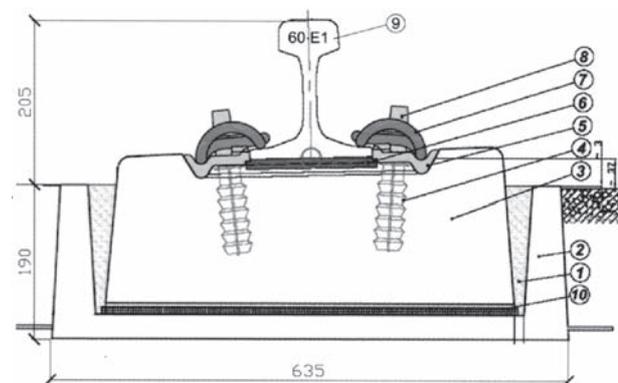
Конструкция пути метрополитена с блочными рельсовыми опорами: 1 — эластичная заливочная масса; 2 — путевой бетонный слой; 3 — опорный блок; 4 — винтовой дюбель; 5 — угловая направляющая; 6 — подрельсовая прокладка; 7 — эластичная клемма; 8 — болт; 9 — рельс; 10 — виброизоляционная прокладка
